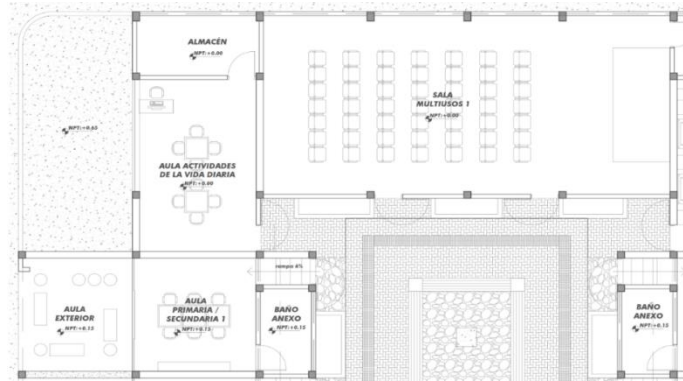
Vista en Planta de Rampa a Segundo Nivel
